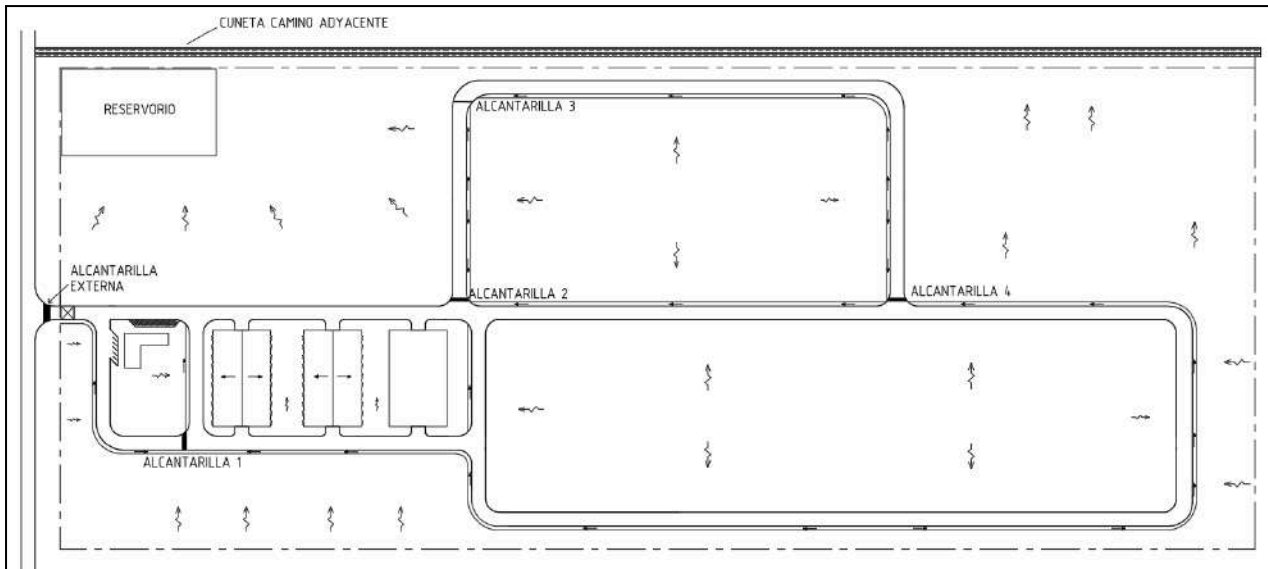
Alcantarillas proyectadas (Fuente: Elaboración propia).
